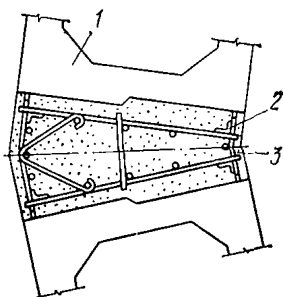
Пример решения стыка блоков (1) с приваркой выпусков арматуры и стержней накладок (3) к переходным уголкам (2)
